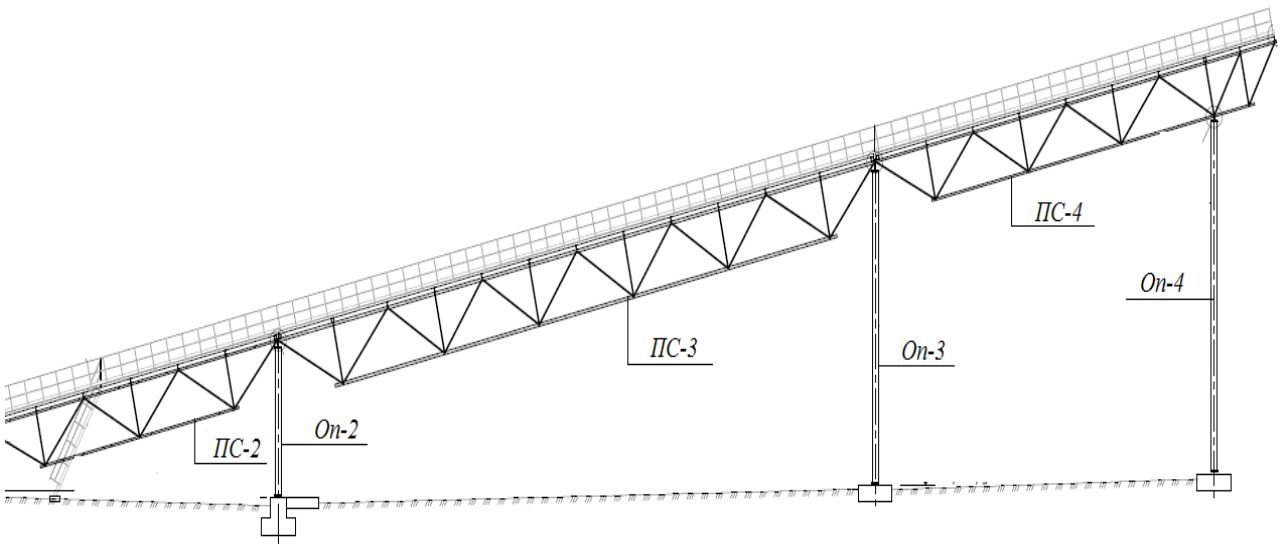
Проектная схема расположения опор и пролетных строений конвейерной галереи
